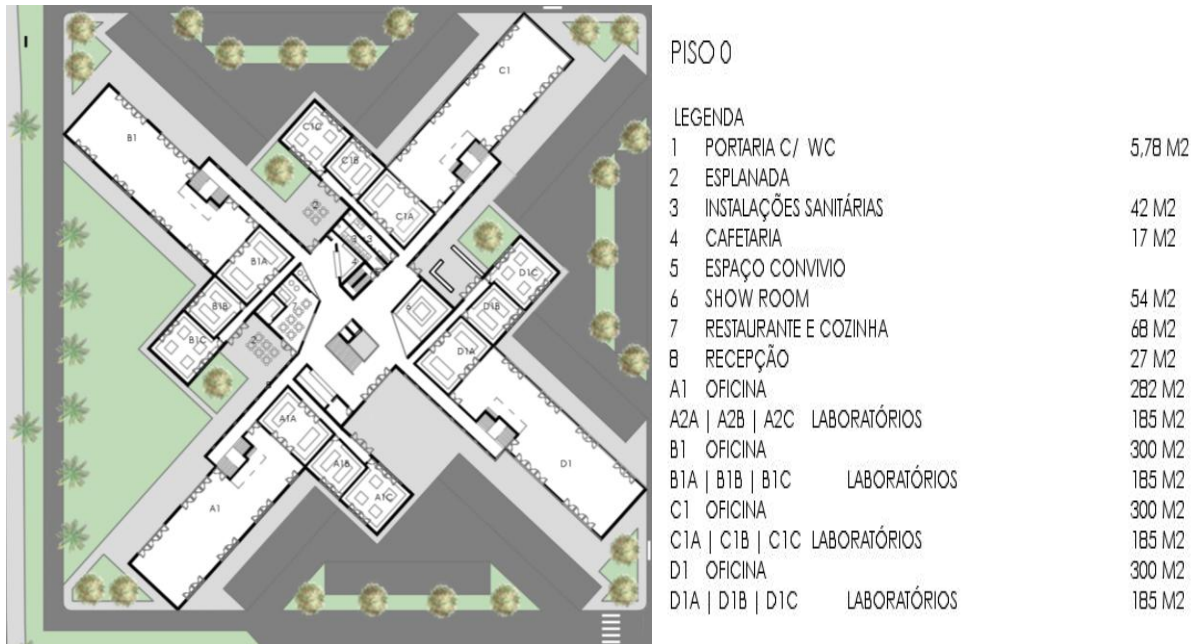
Planta Baixa do piso 0 e sua respectivas dimensões
